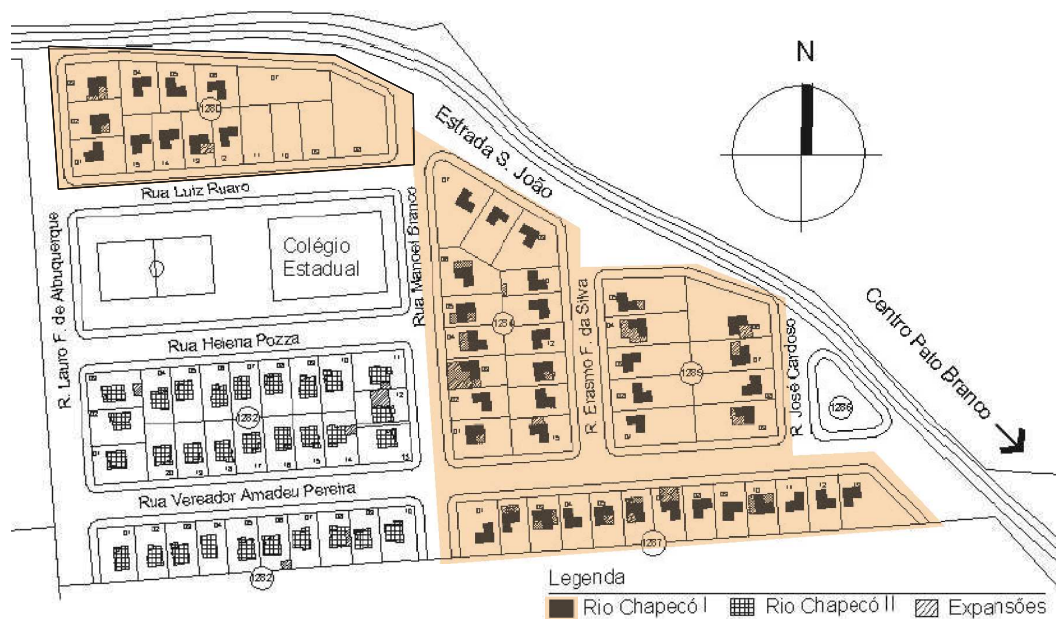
PLANTA DOS CONJUNTOS RIO CHAPECÓ (SEM ESCALA).
